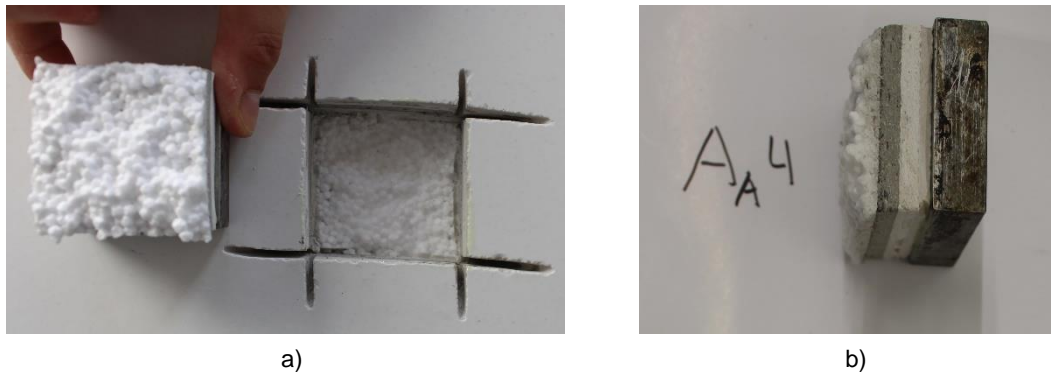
Ensaio de aderência Aa4: a) Vista de frente; b) Vista em perfil
